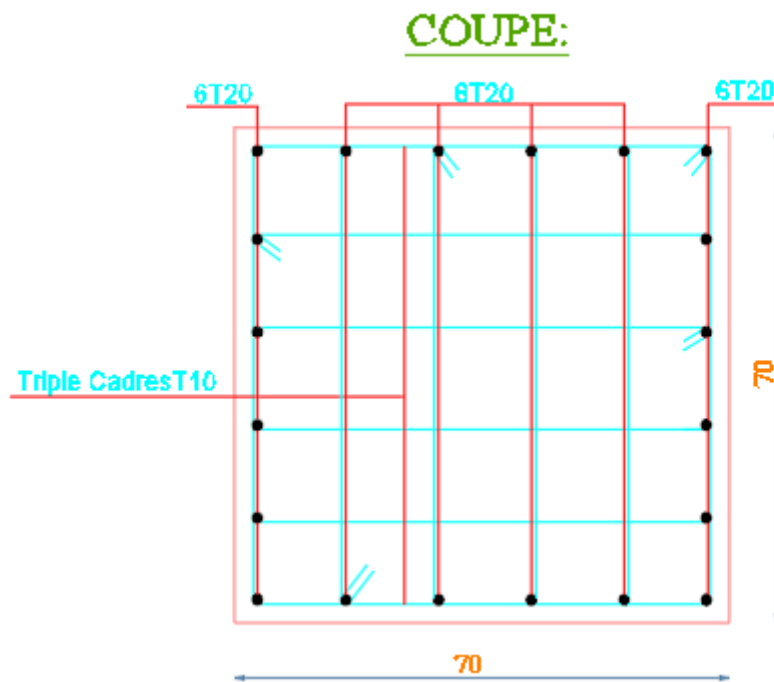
Schéma du ferrailage du poteau (70x70) cm²
